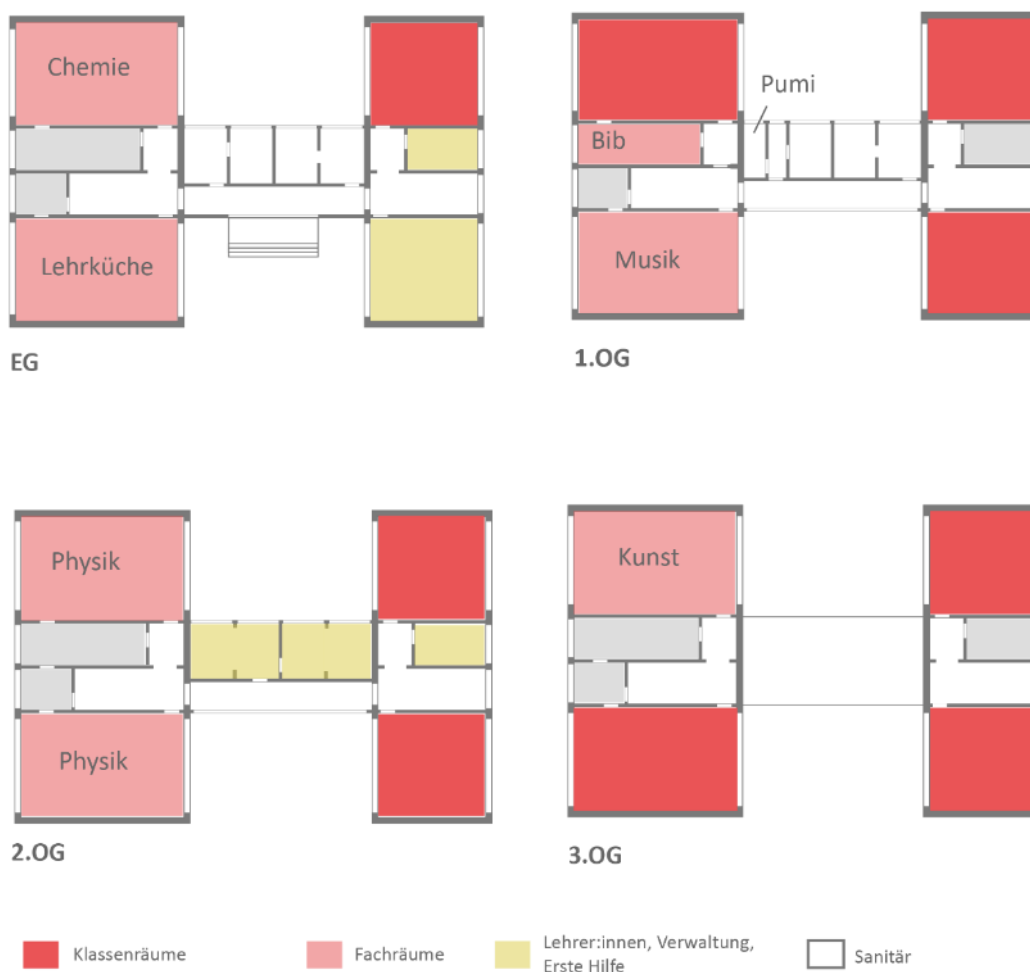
Grundrisse und Raumverteilung im derzeitigen Bestand
